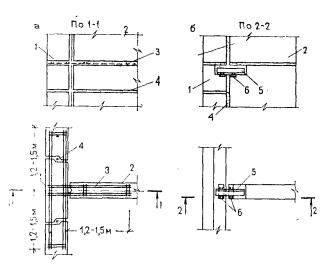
18. Связи наружных крупноблочных стен с внутреннямя стенами
